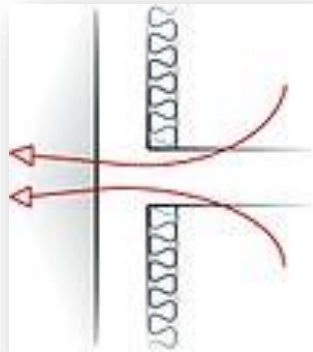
Jonction plancher intermédiaire/mur extérieur
